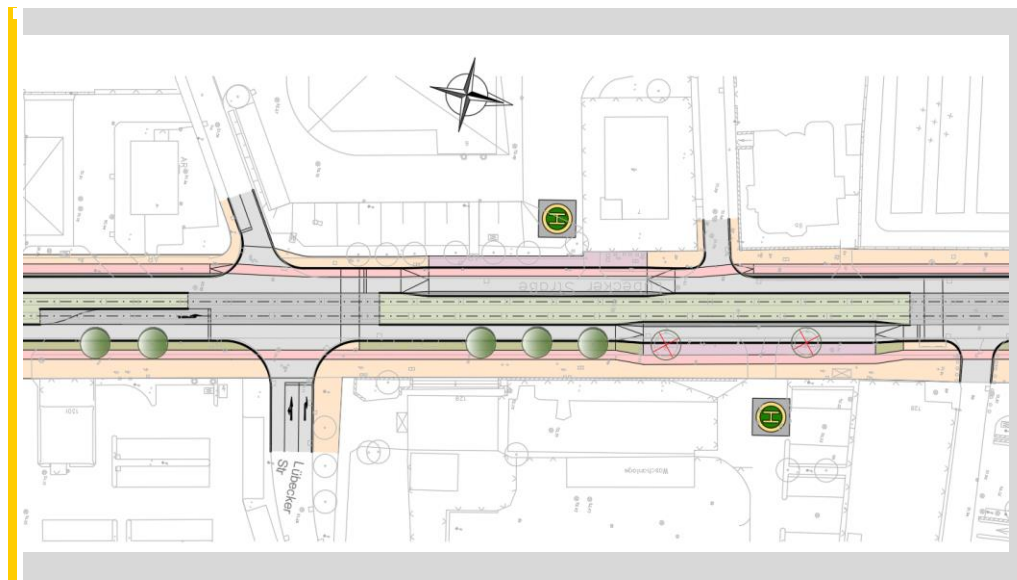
Lübecker Straße Süd, Lageplanausschnitt V1
